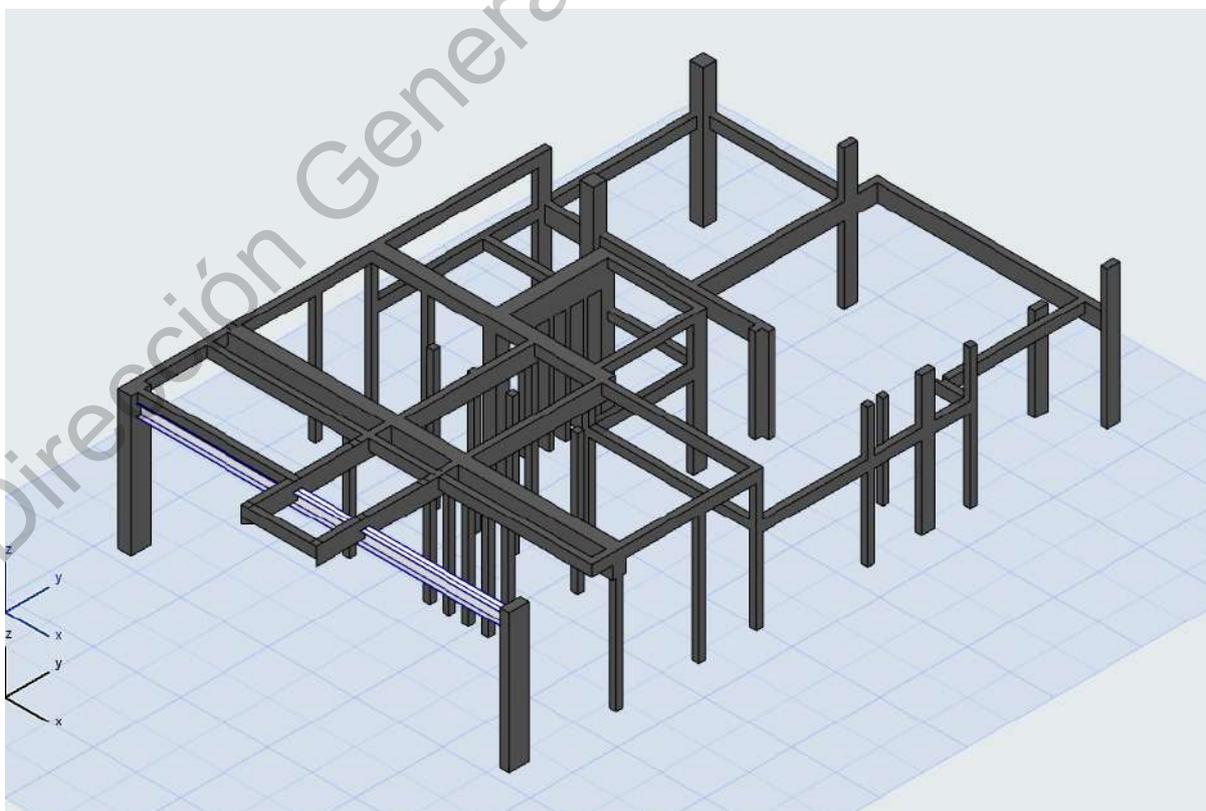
Columnas de concreto, Vigas de concreto y Viga de acero de Primer Nivel de Proyecto 003.
